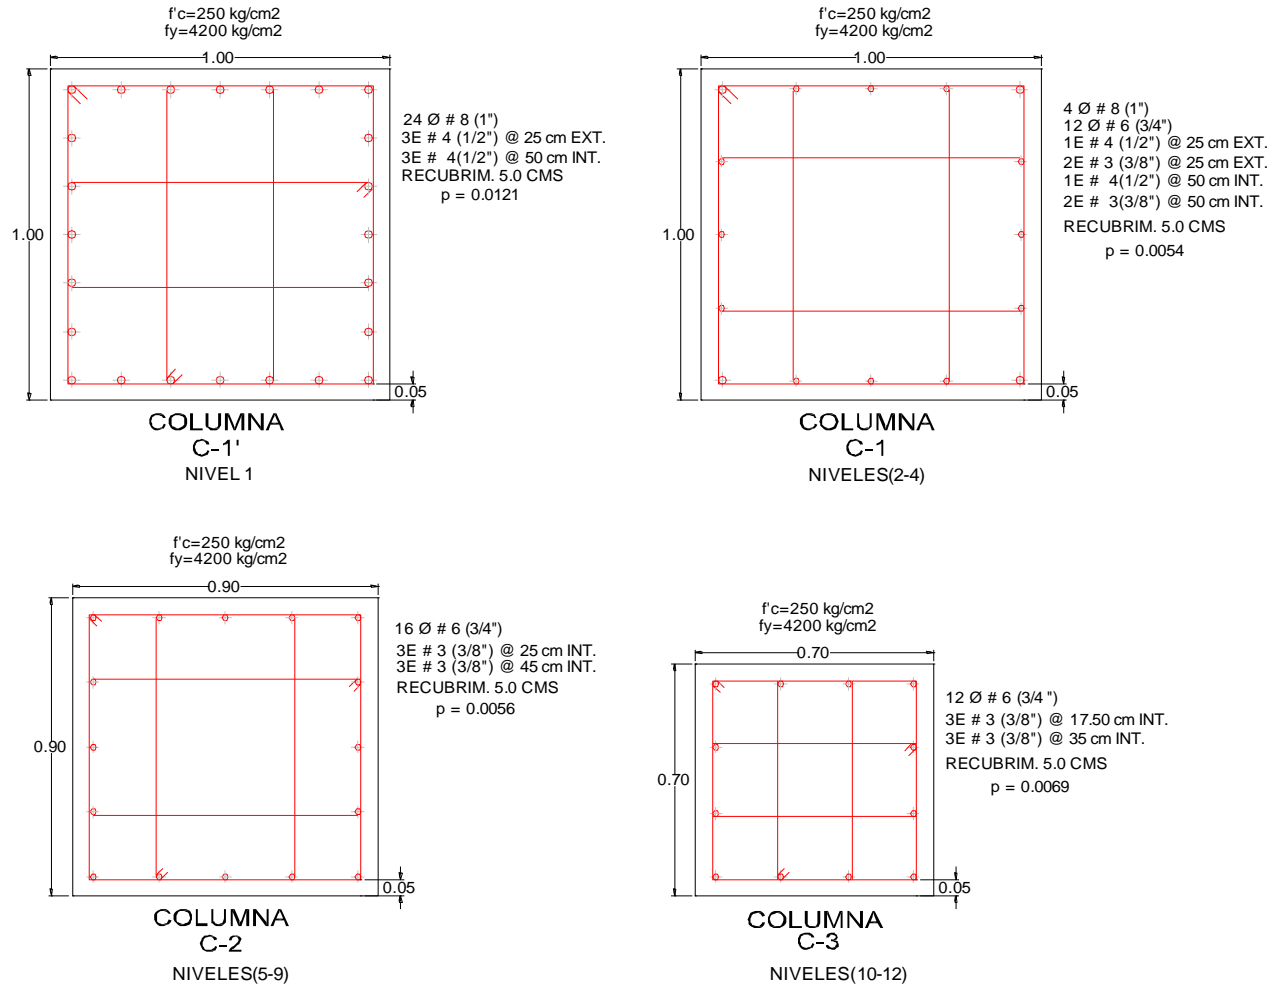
Detallado de armado de columnas del marco de 12 niveles con base a secciones gruesas.
